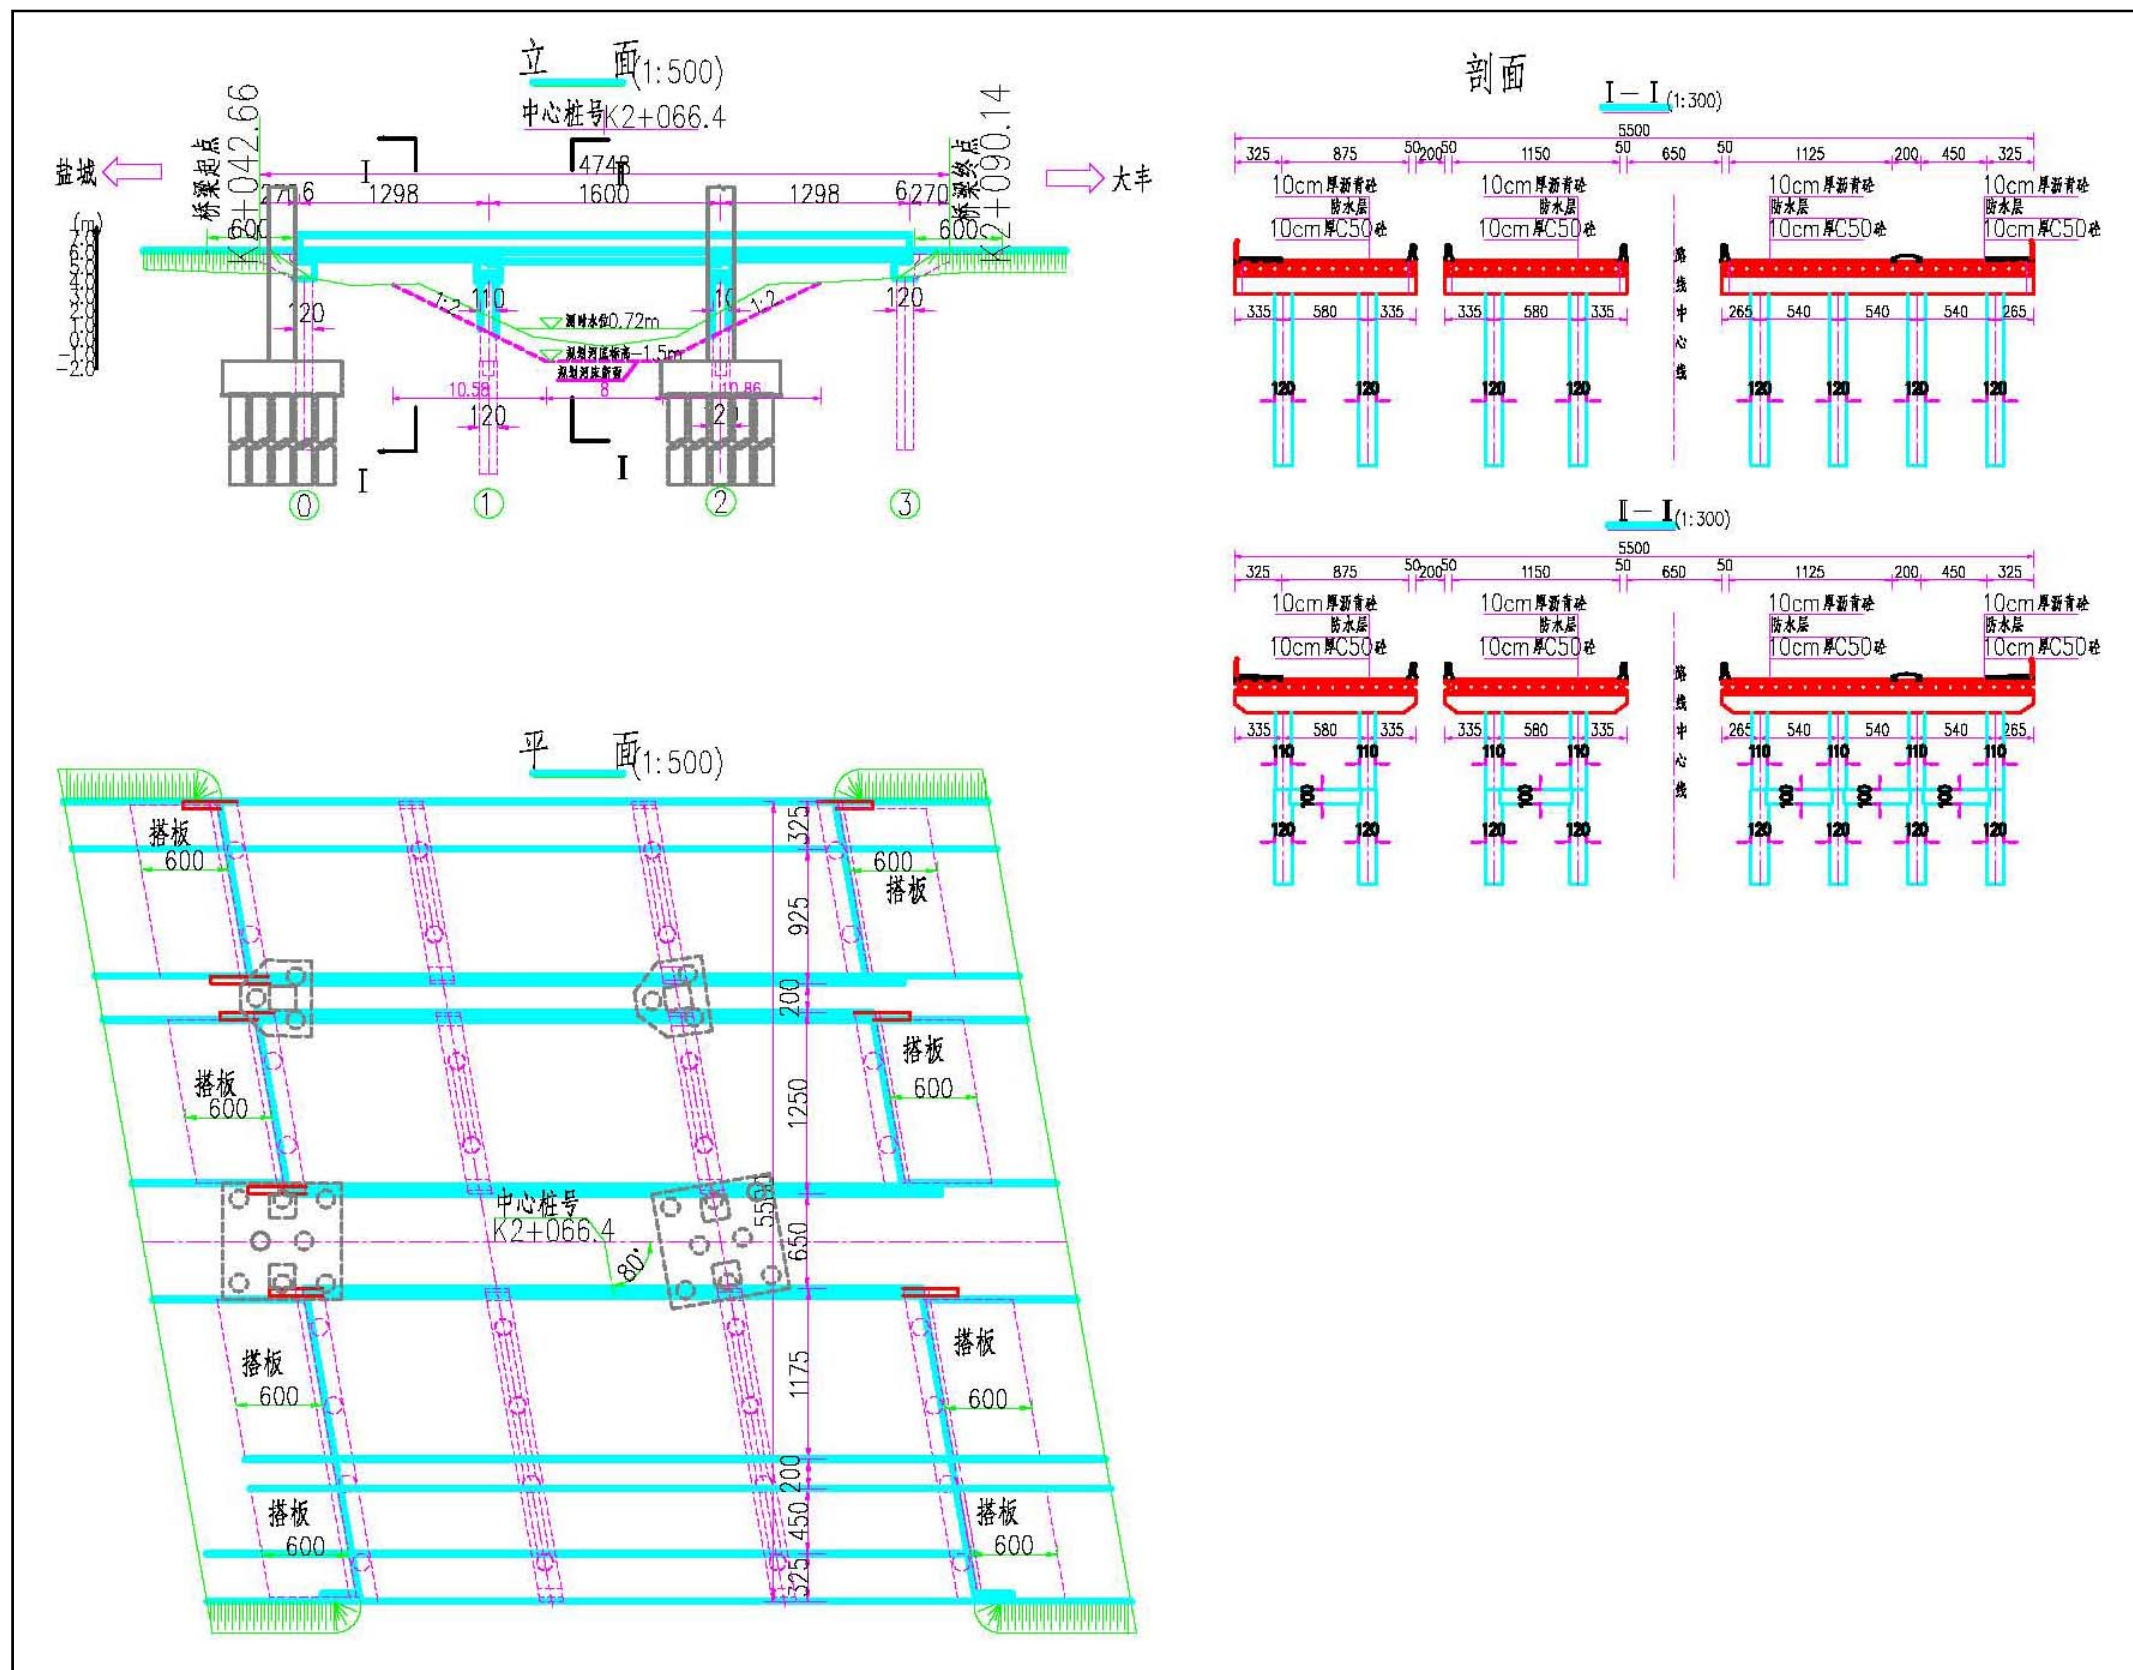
杨桥桥型平面布置图 (含立面、横断剖面)
